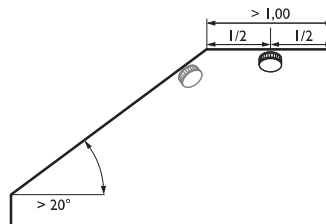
Gerade Montagefläche mindestens 1 m lang und 1 m breit
